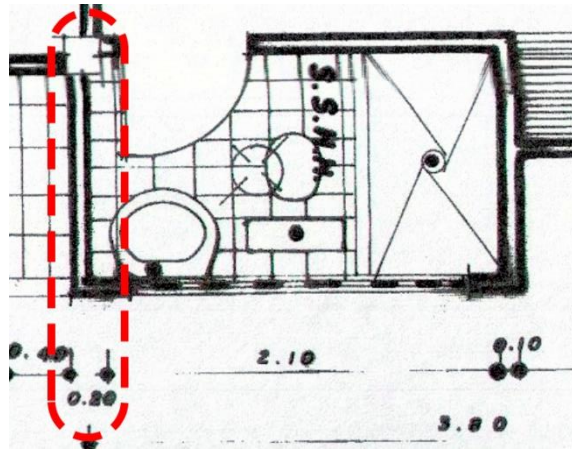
Secciones Columnas – “Vivienda del Sr. Walter Santos”.
